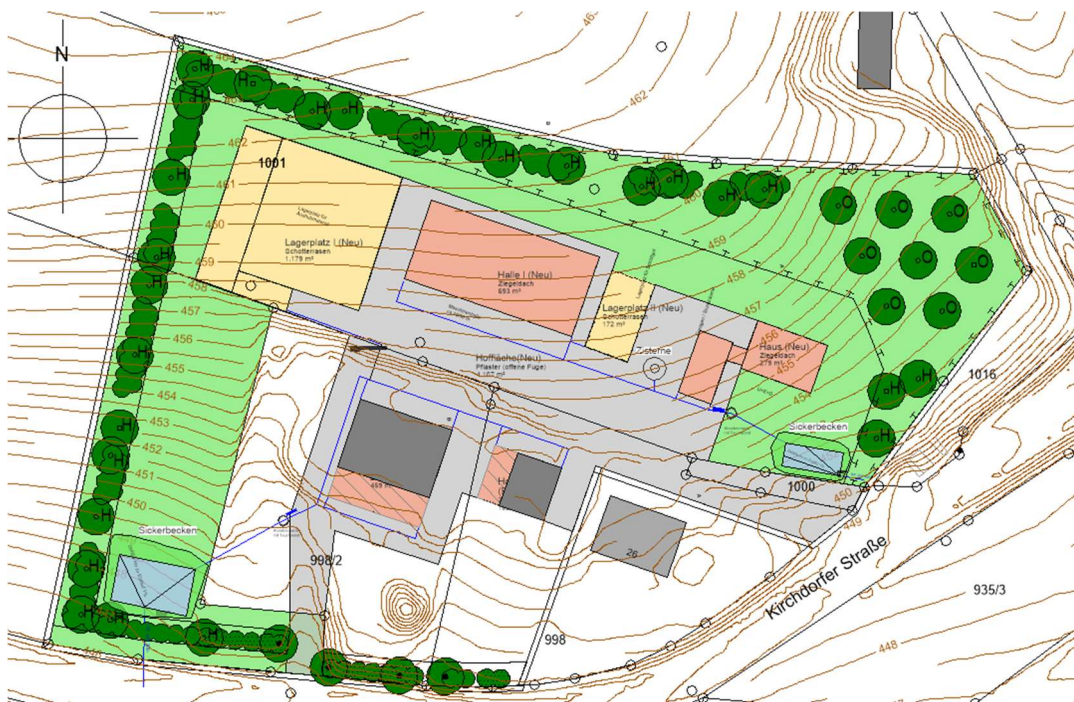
Übersicht Bauungsplan inkl. Entwässerungseinrichtung
